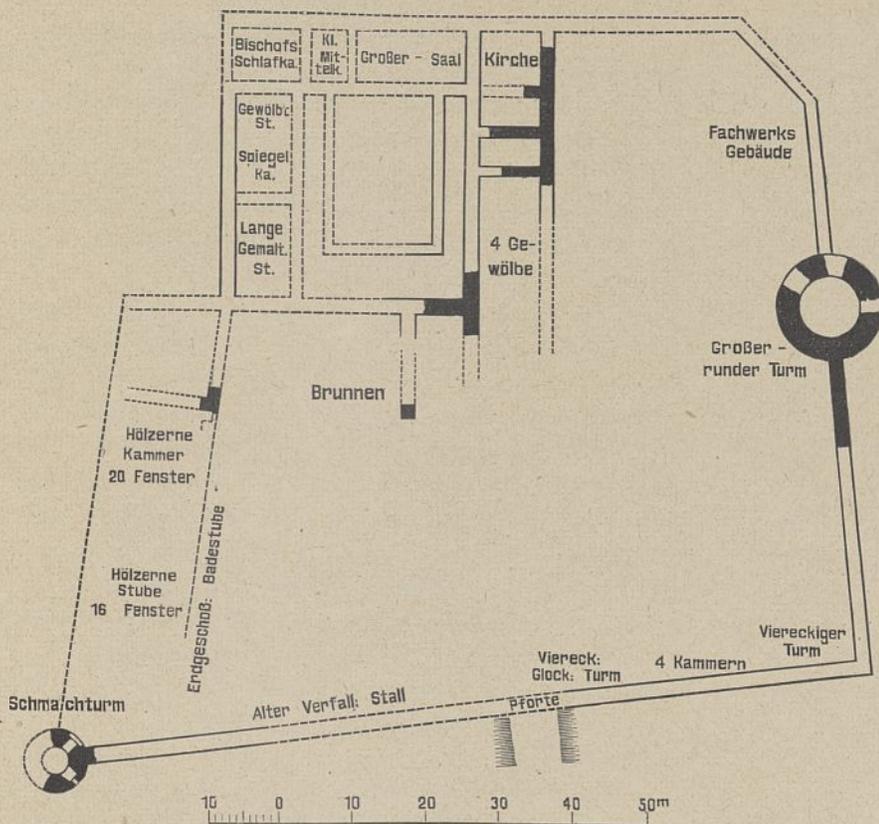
Die Bischofsburg Pilten. Grundriß. 1:1000.
